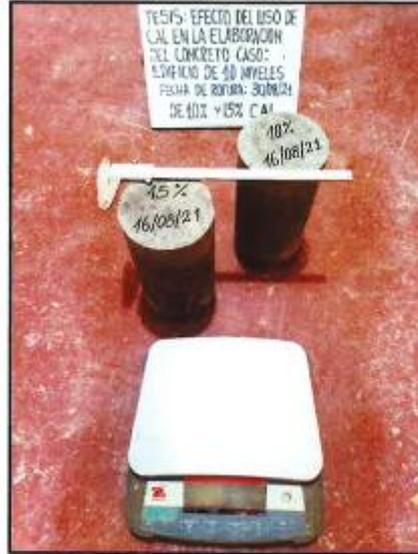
Vista de la probetas de concreto de 10 y 15 % de cal.
